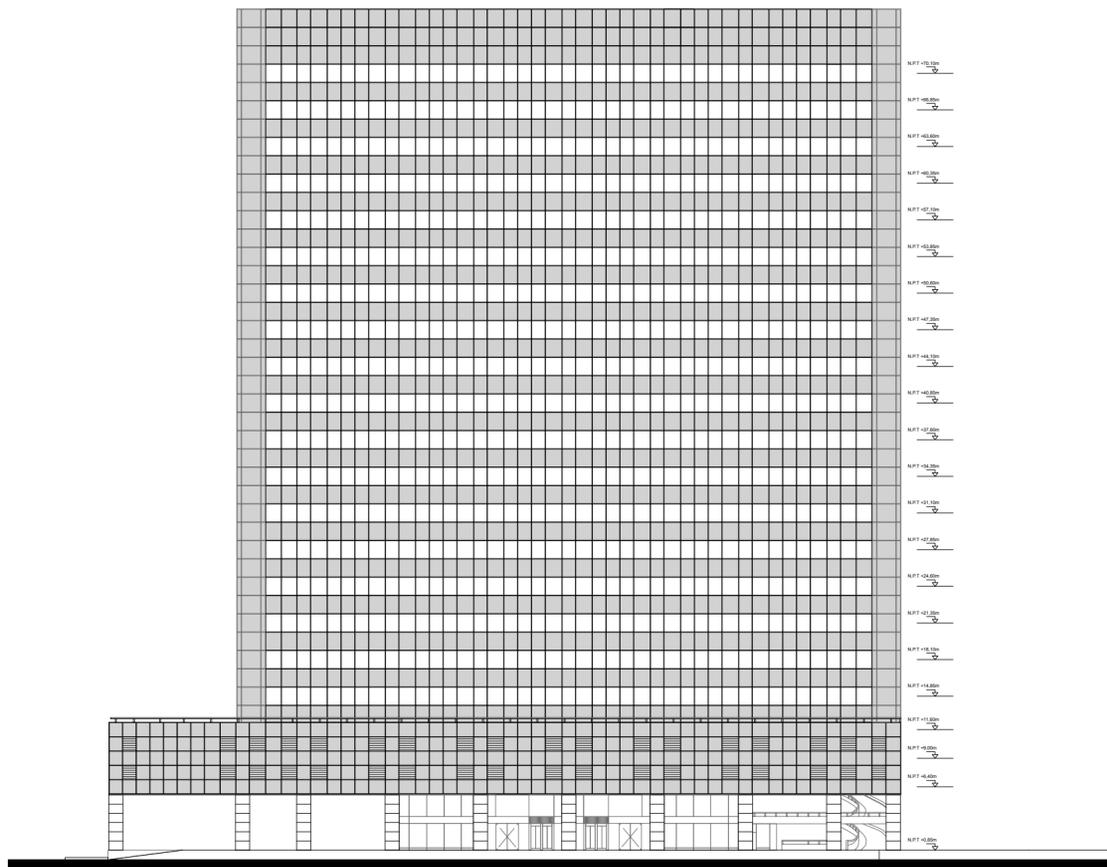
Vista desde calle Ingeniero Enrique Butty.
